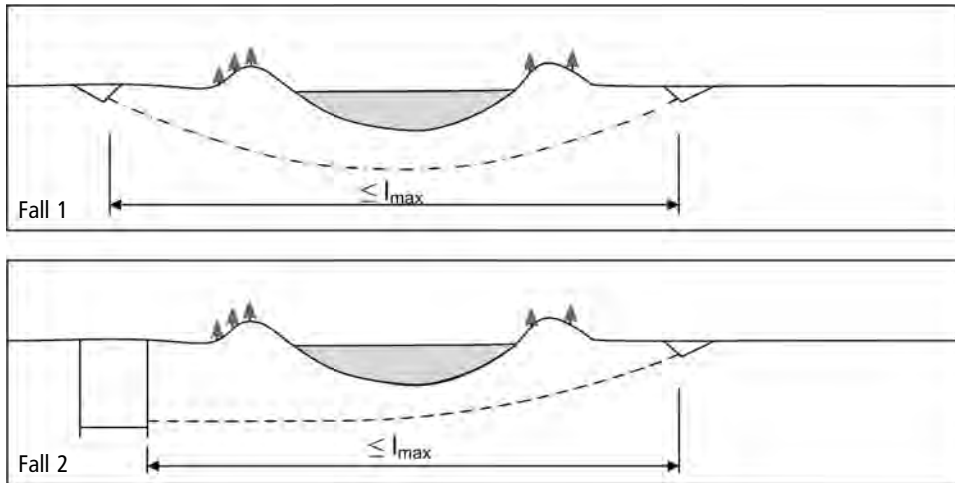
Fall 1: Startschacht an der Geländeoberfläche; Fall 2: Bohrung mit Startbaugrube nach [9]
